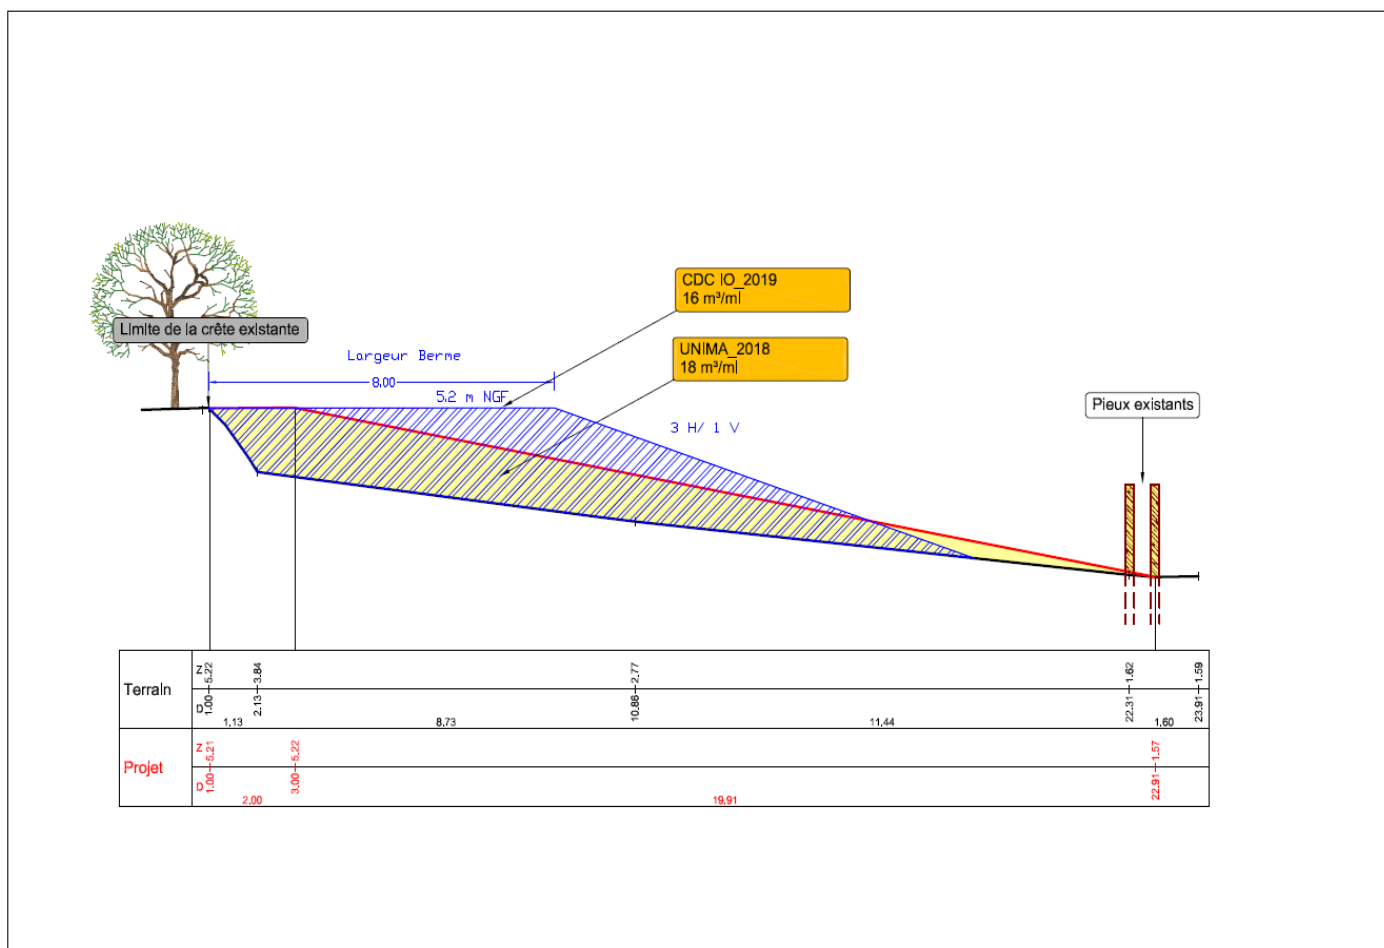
PLAN EN COUPE DU RECHARGEMENT
